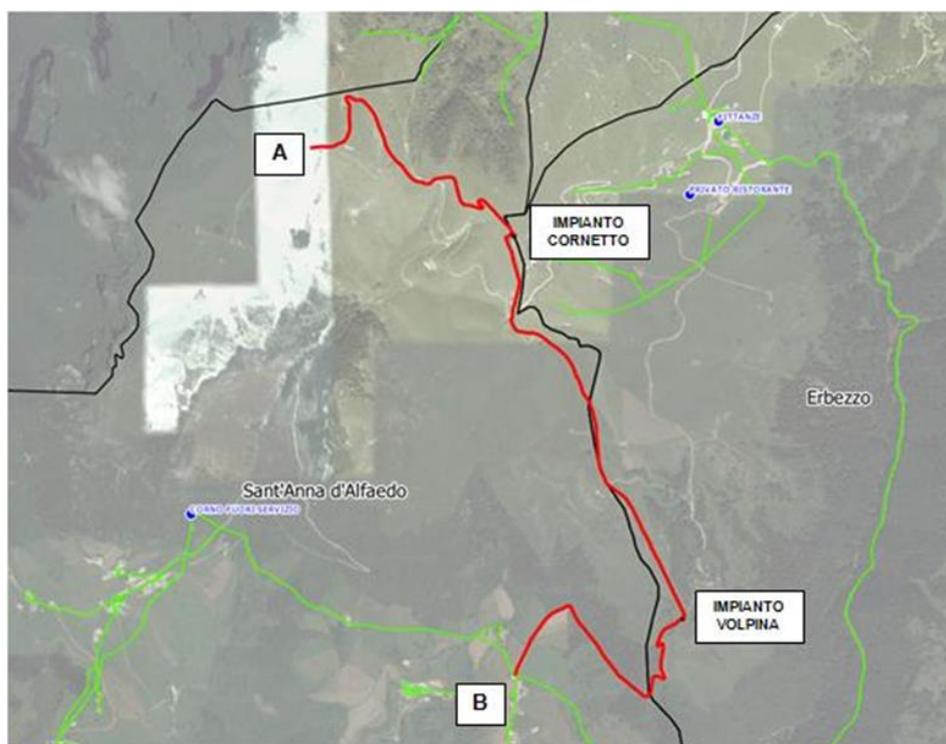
Planimetria generale del tracciato AB. In rosso il tracciato di progetto, in verde la rete esistente
